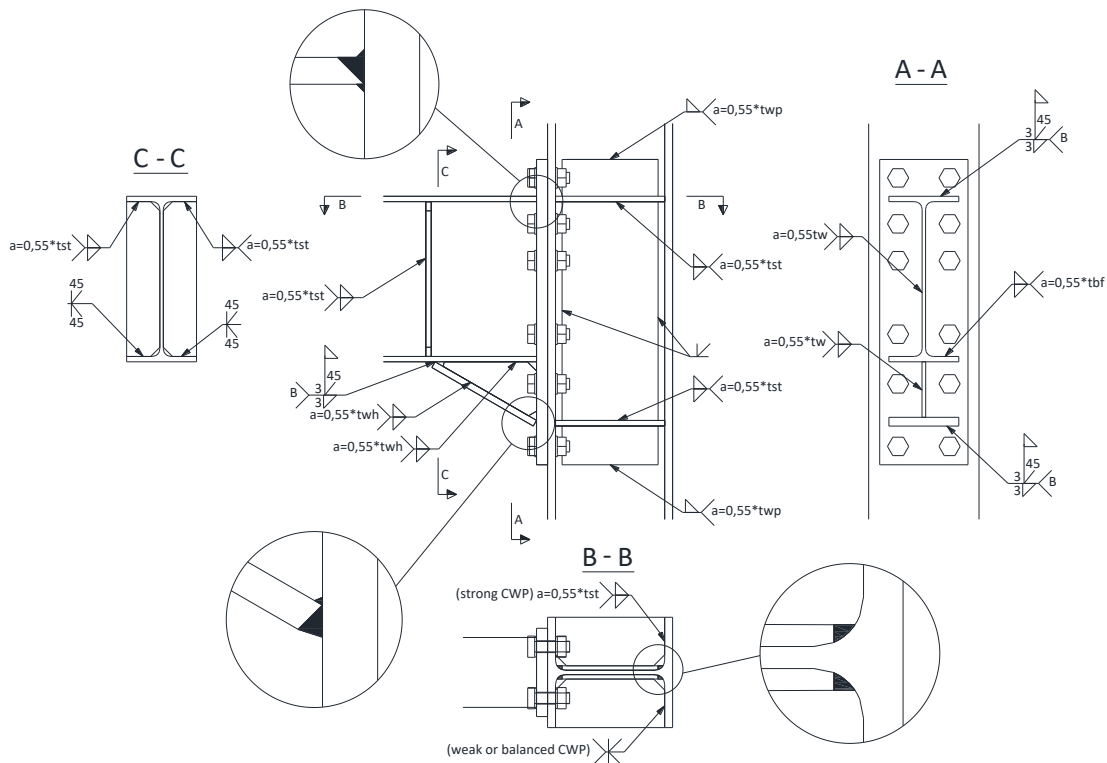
Soudures des assemblages avec jarrets
